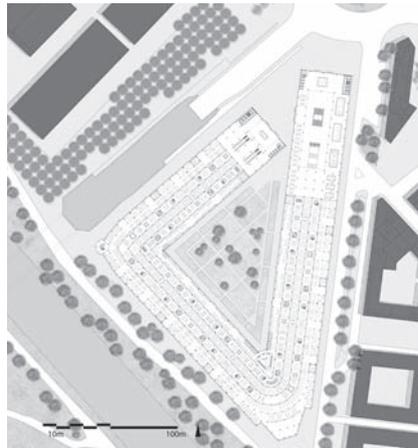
Grundriss Erdgeschoss, 2009.
